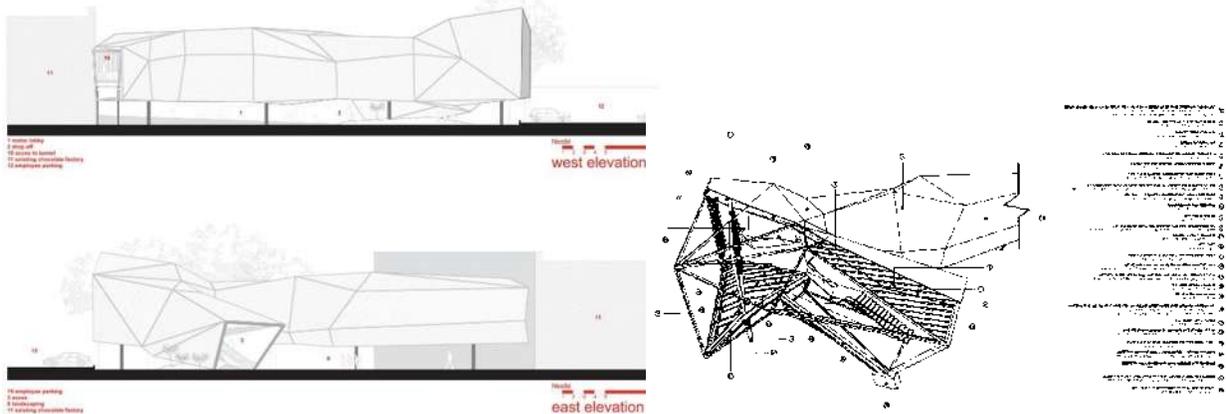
| Fachadas (izquierda) y estructura (derecha).
